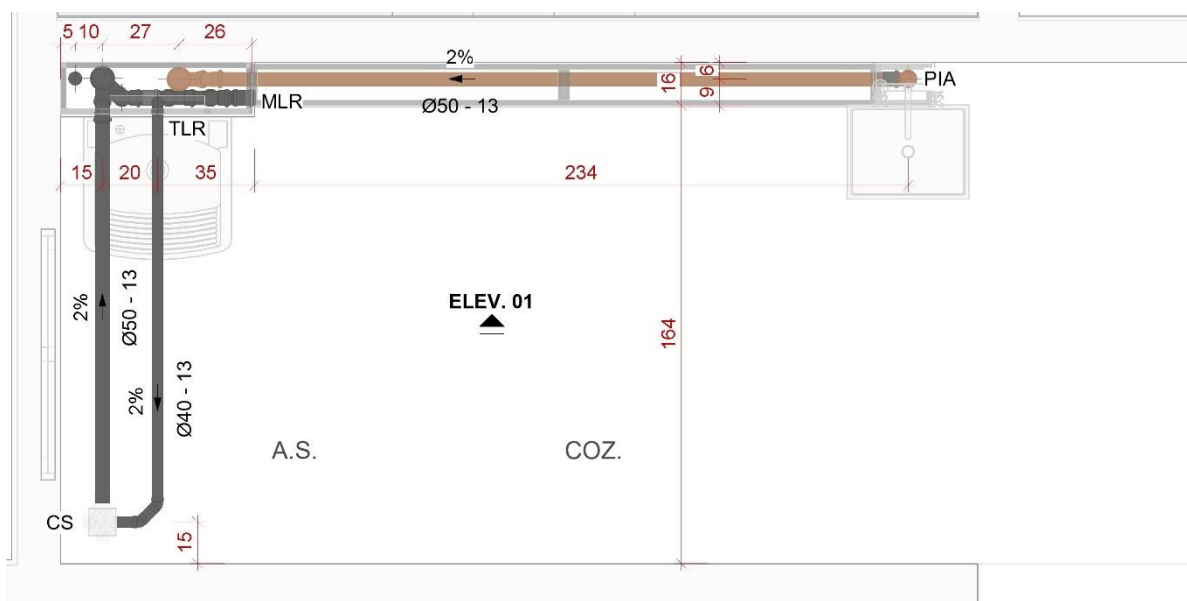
Planta do pavimento tipo projeto sanitário
